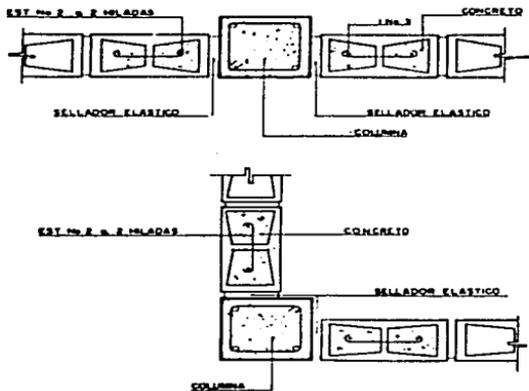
Tipo de refuerzo horizontal y vertical muros de block de concreto
